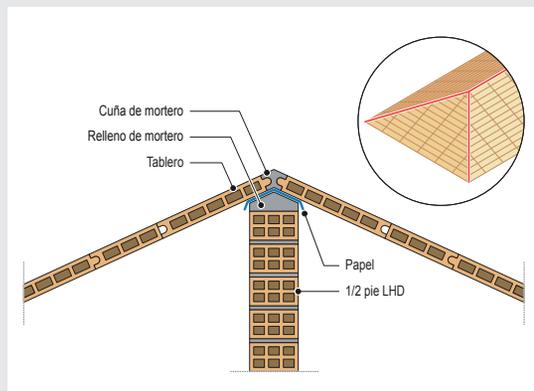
Apoyo del tablero sobre caballete en cubierta sobre forjado
